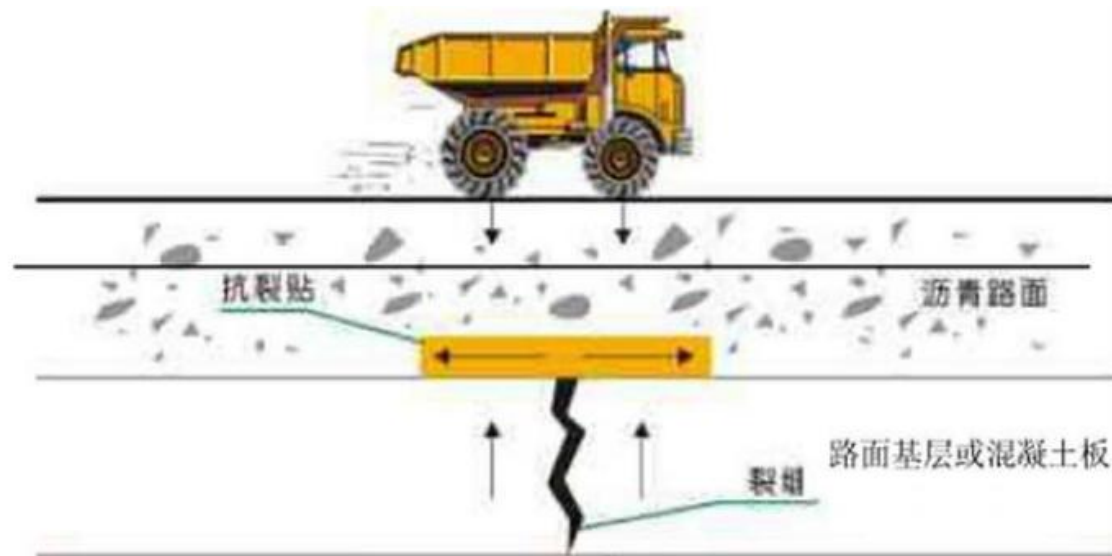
抗裂贴设置于混凝土板顶面示意图
